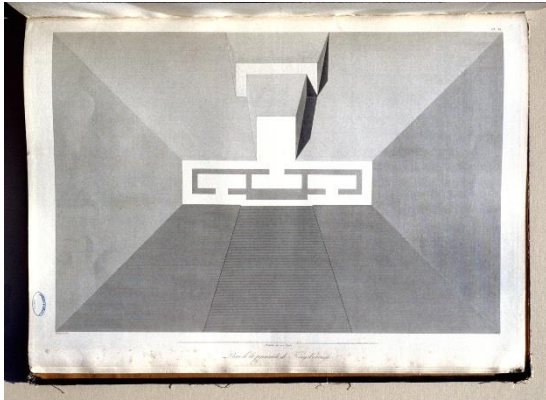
Waldeck Frederick. Planta arquitectónica del edificio del Adivino. 1838. Reed College. 2016
